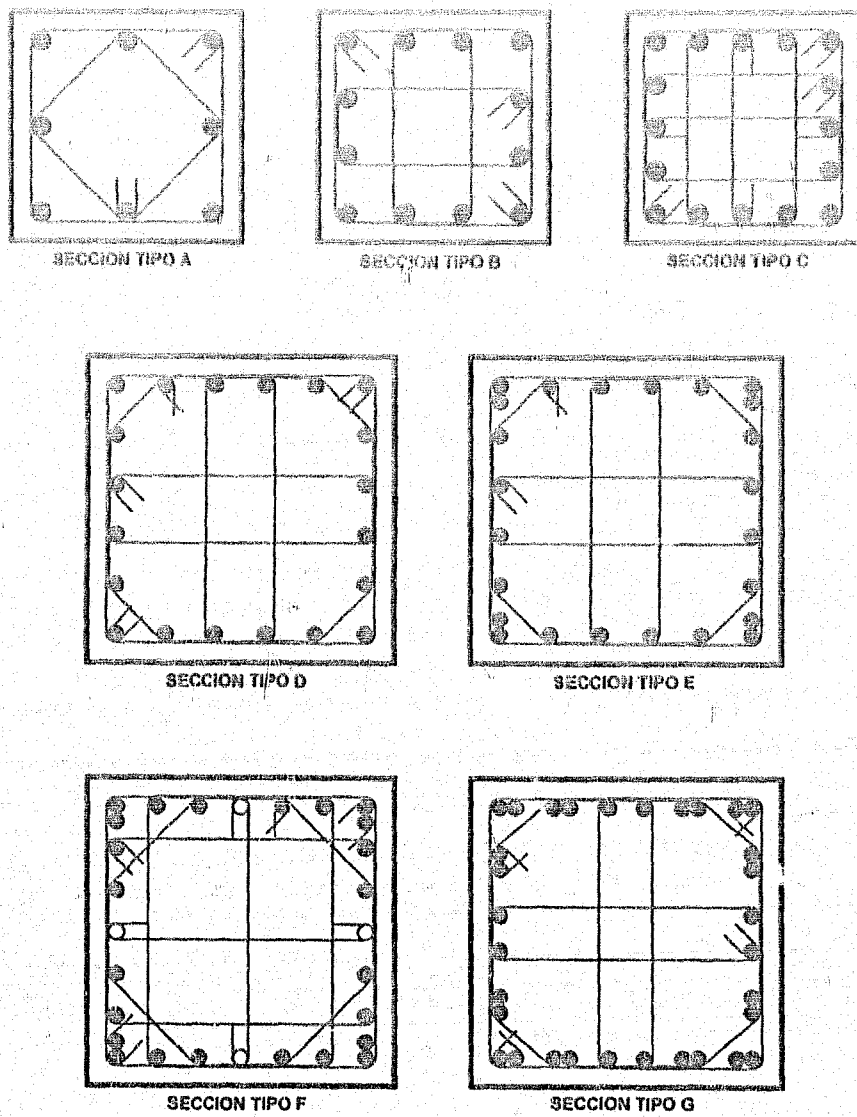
Refuerzo longitudinal y transversal en columnas marco con disipadores.
